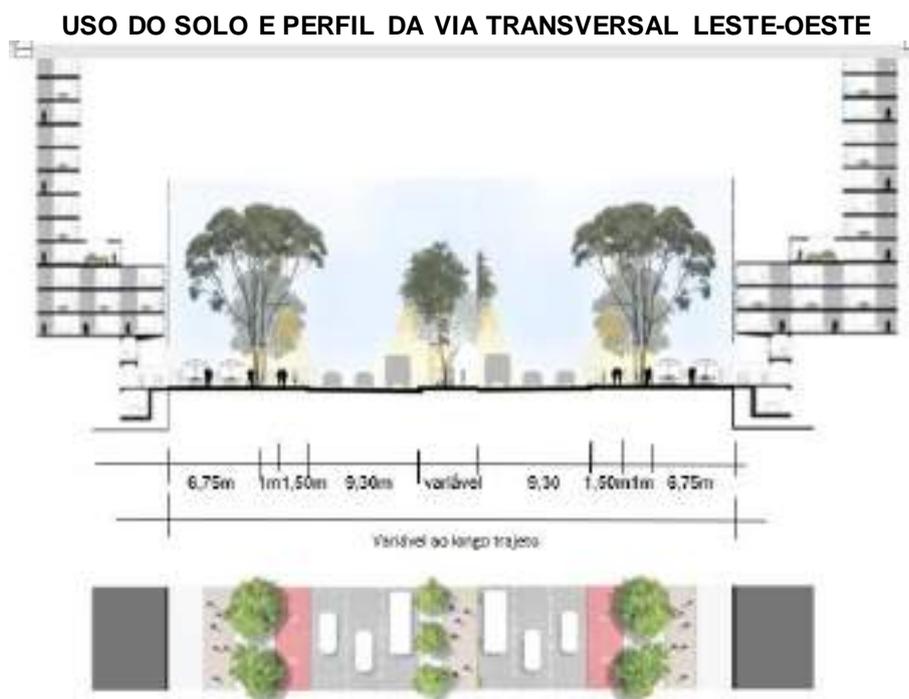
Uso do solo e perfil da Via Transversal Leste-Oeste.
